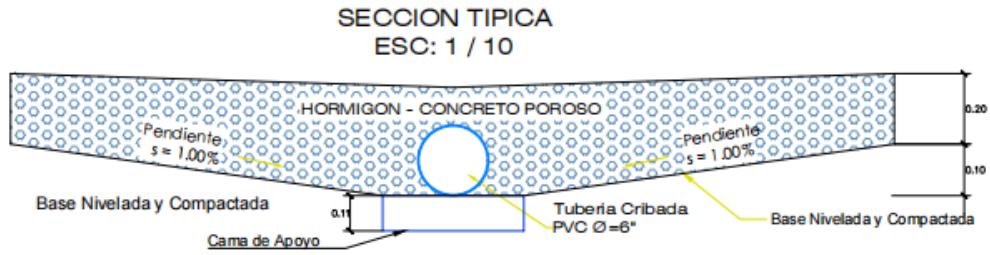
Sección típica de concreto permeable con sistema de drenaje.
